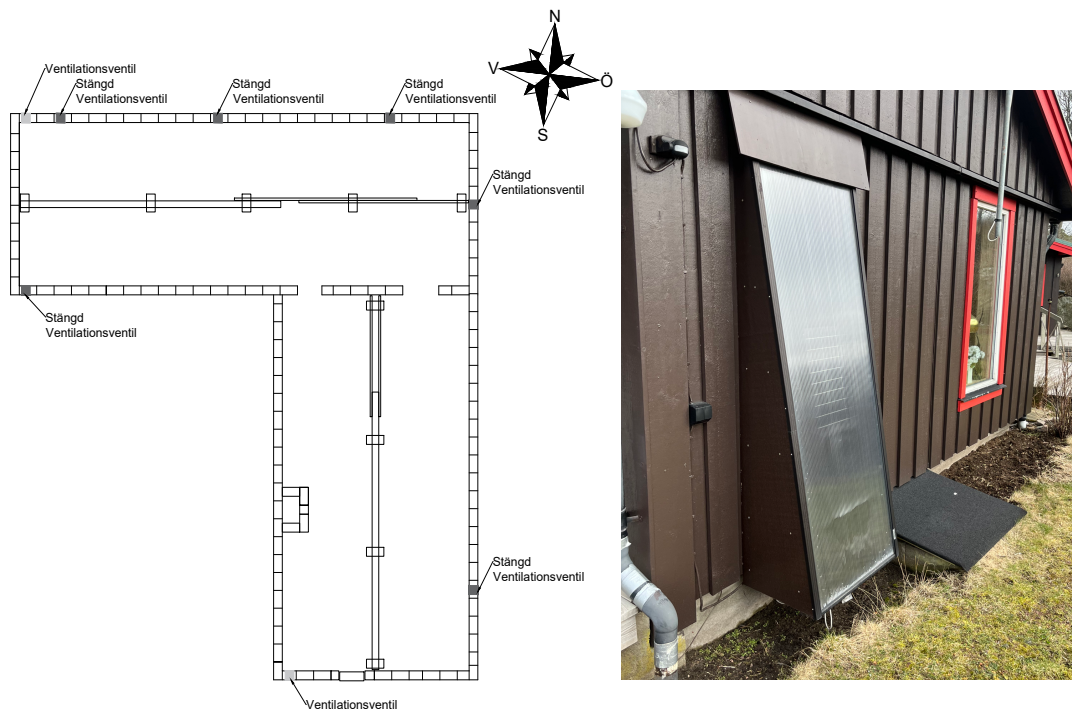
Utformning av grundmur, plintar och bärlina i uteluftsventilerad krypgrund.
